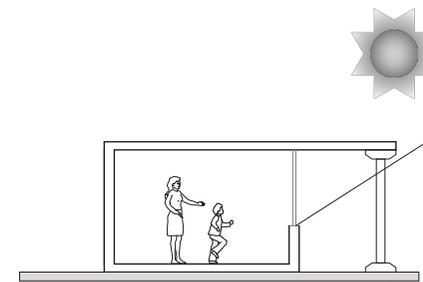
Pórtico. FUENTE: Elaboración propia.
